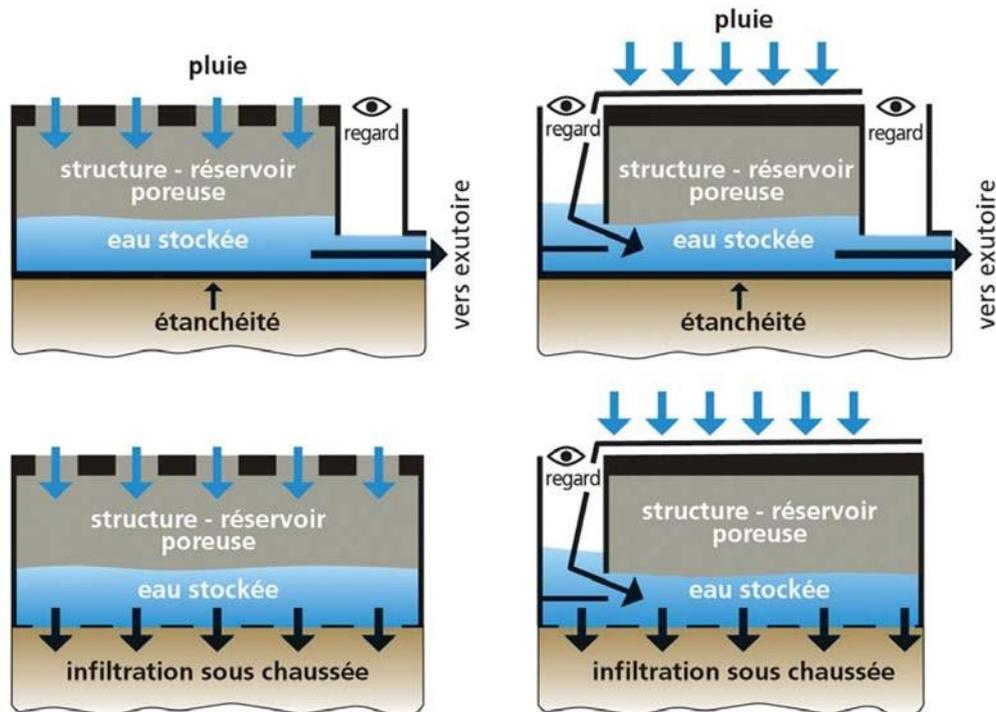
Les techniques alternatives chaussées et structures réservoirs.
